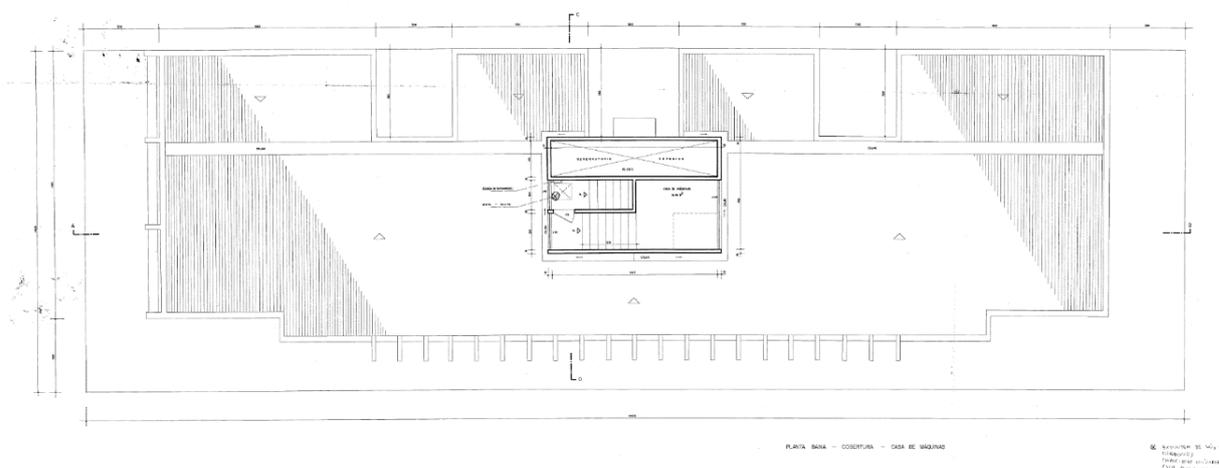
Planta baixa da cobertura, com telhados embutidos e áreas funcionais.
